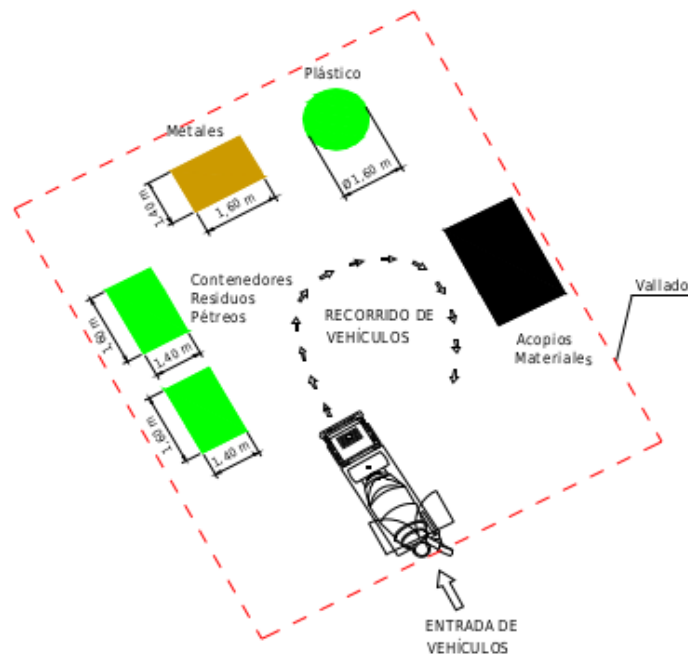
Esquema de instalaciones previstas en la obra. Fuente: Elaboración propia
